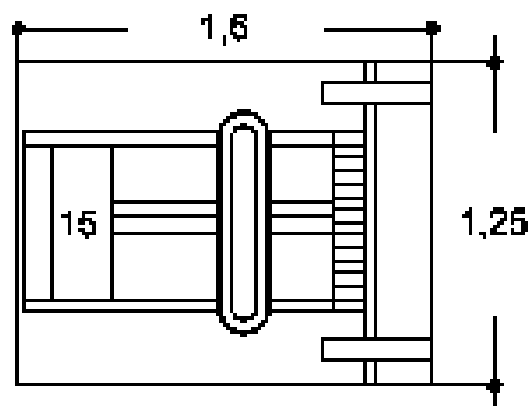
APARATO DE PRESIÓN EN LAS PIERNAS
